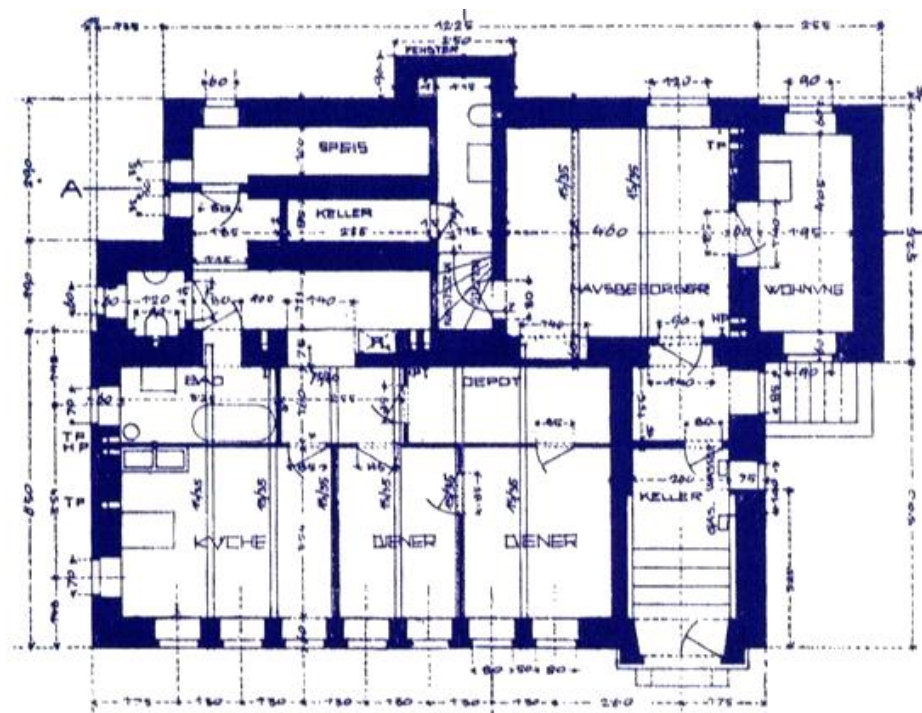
Grundriss am Beispiel des Kellergeschosses [27]
